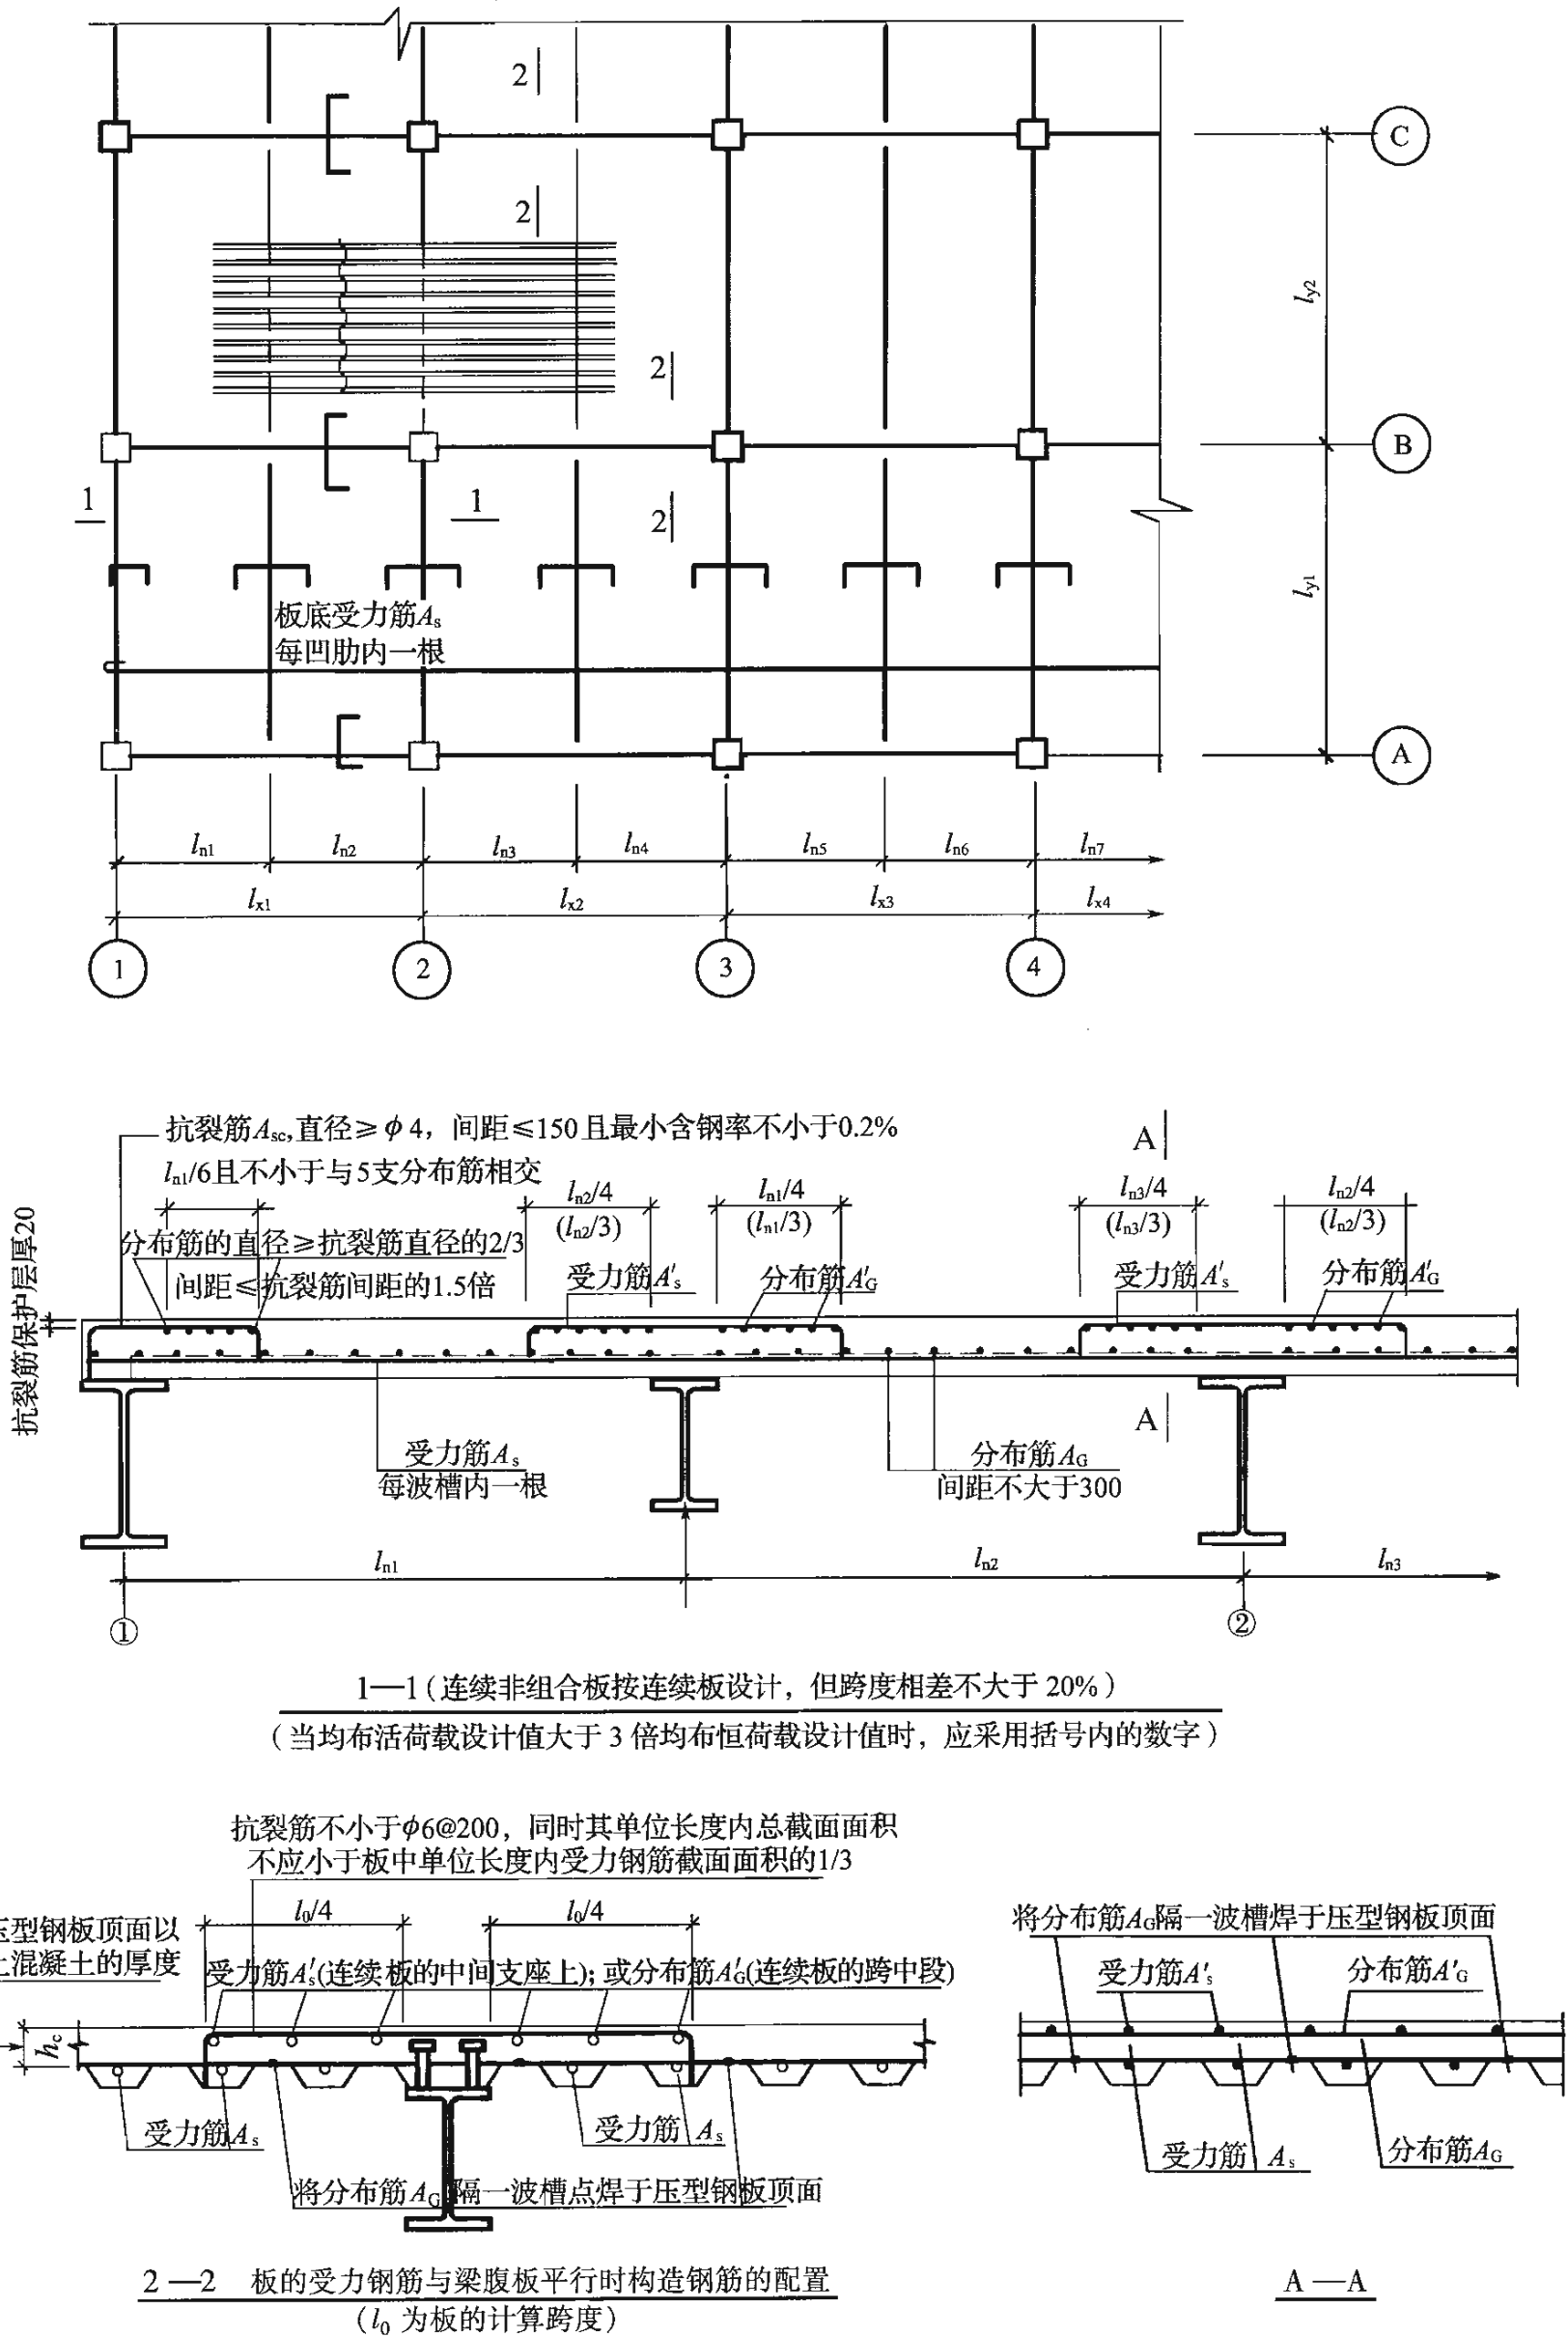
梁、板平面布置及板的配筋示意图
